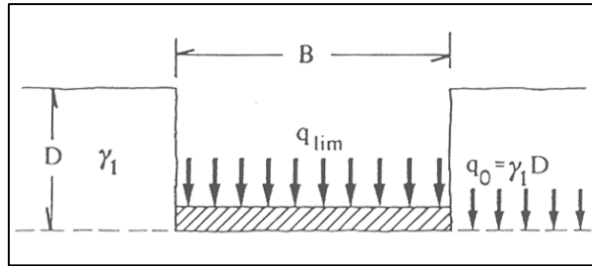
SCHEMA GEOMETRIA FONDAZIONE
